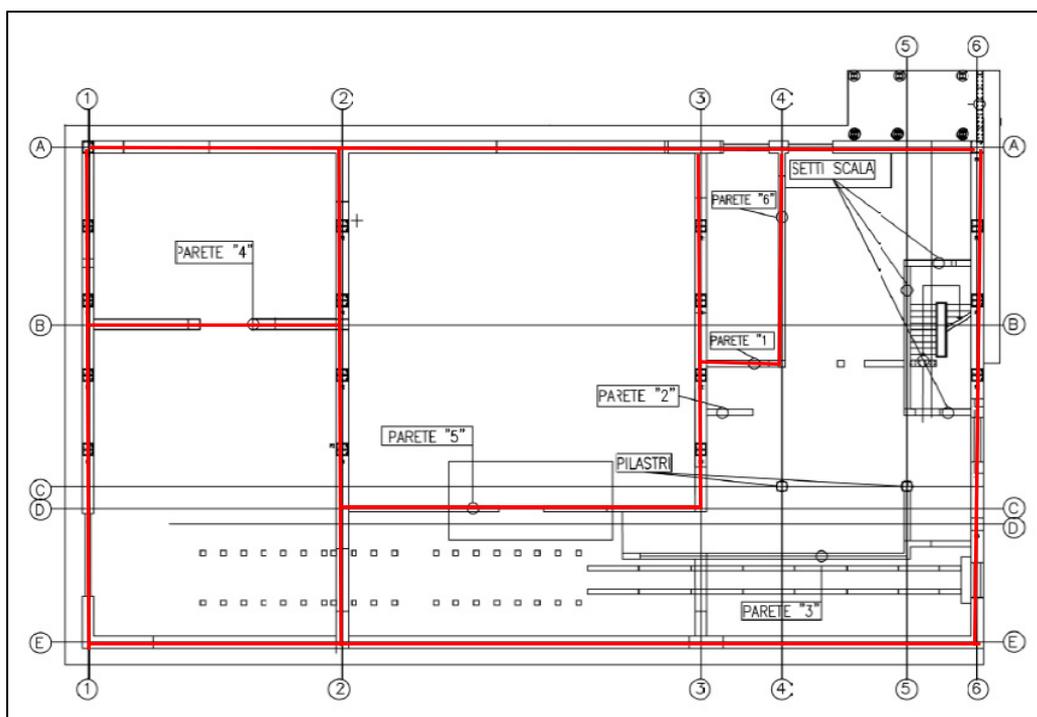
Planimetria di progetto con indicazione (in rosso) delle strutture in elevazione realizzate
